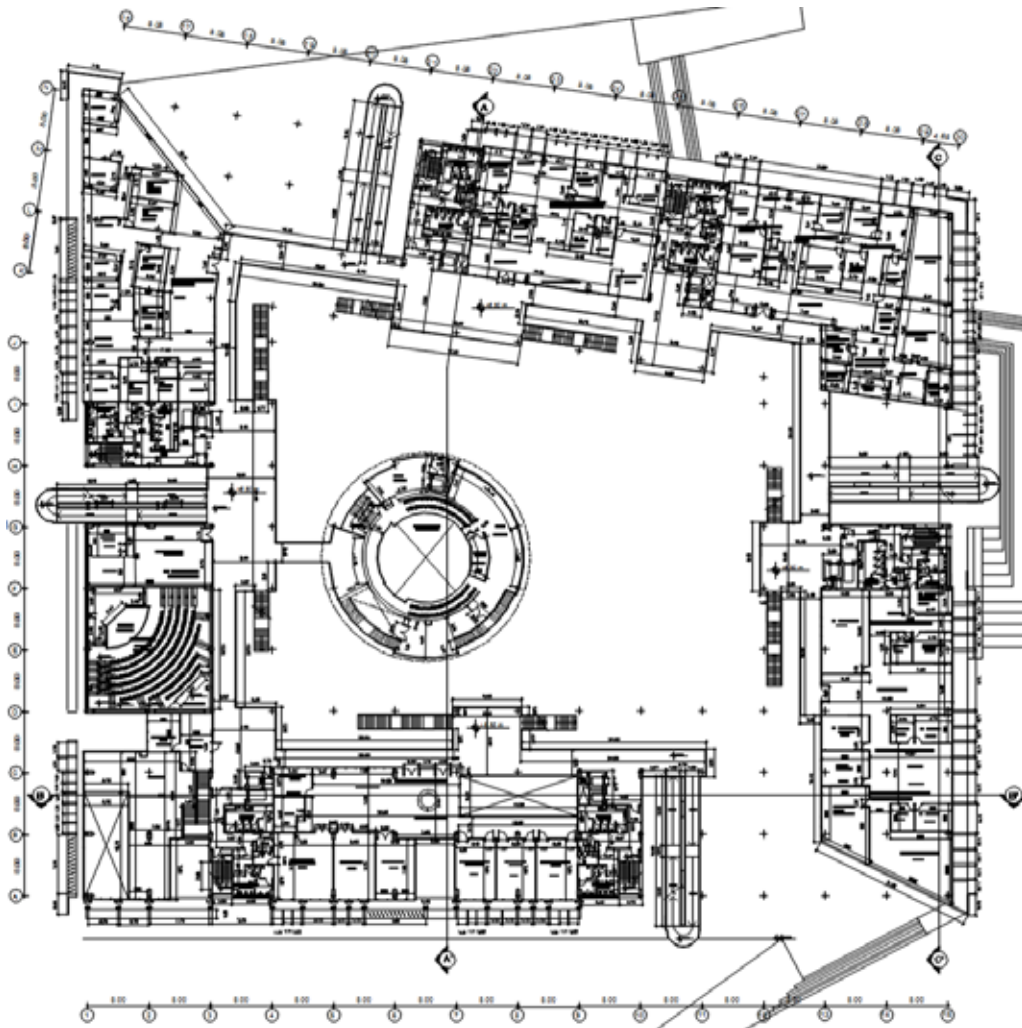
Planta de Primer Piso Nivel+6.50m (2017)
